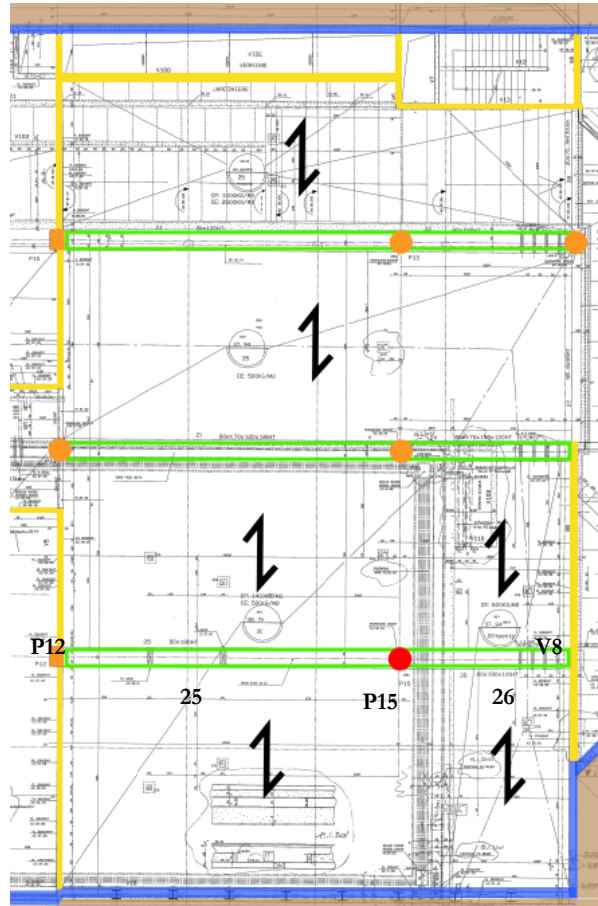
Extracto del plano de encofrados de la construcción inicial. En azul: muros enterrados, amarillo: muros, naranja: pilares, rojo: pilar a quitar, verde: vigas de hormigón, negro: dirección de la luz de las losas
